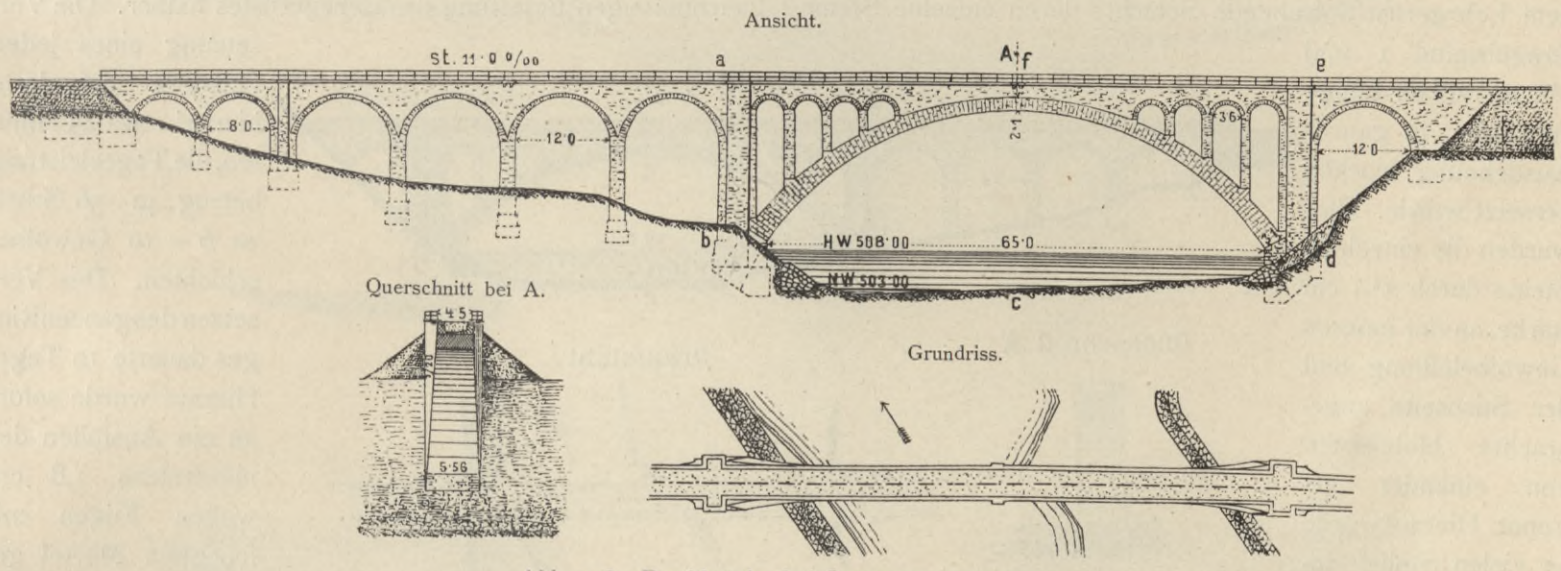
Pruthbrücke bei Jaremcze. 1:1000.
